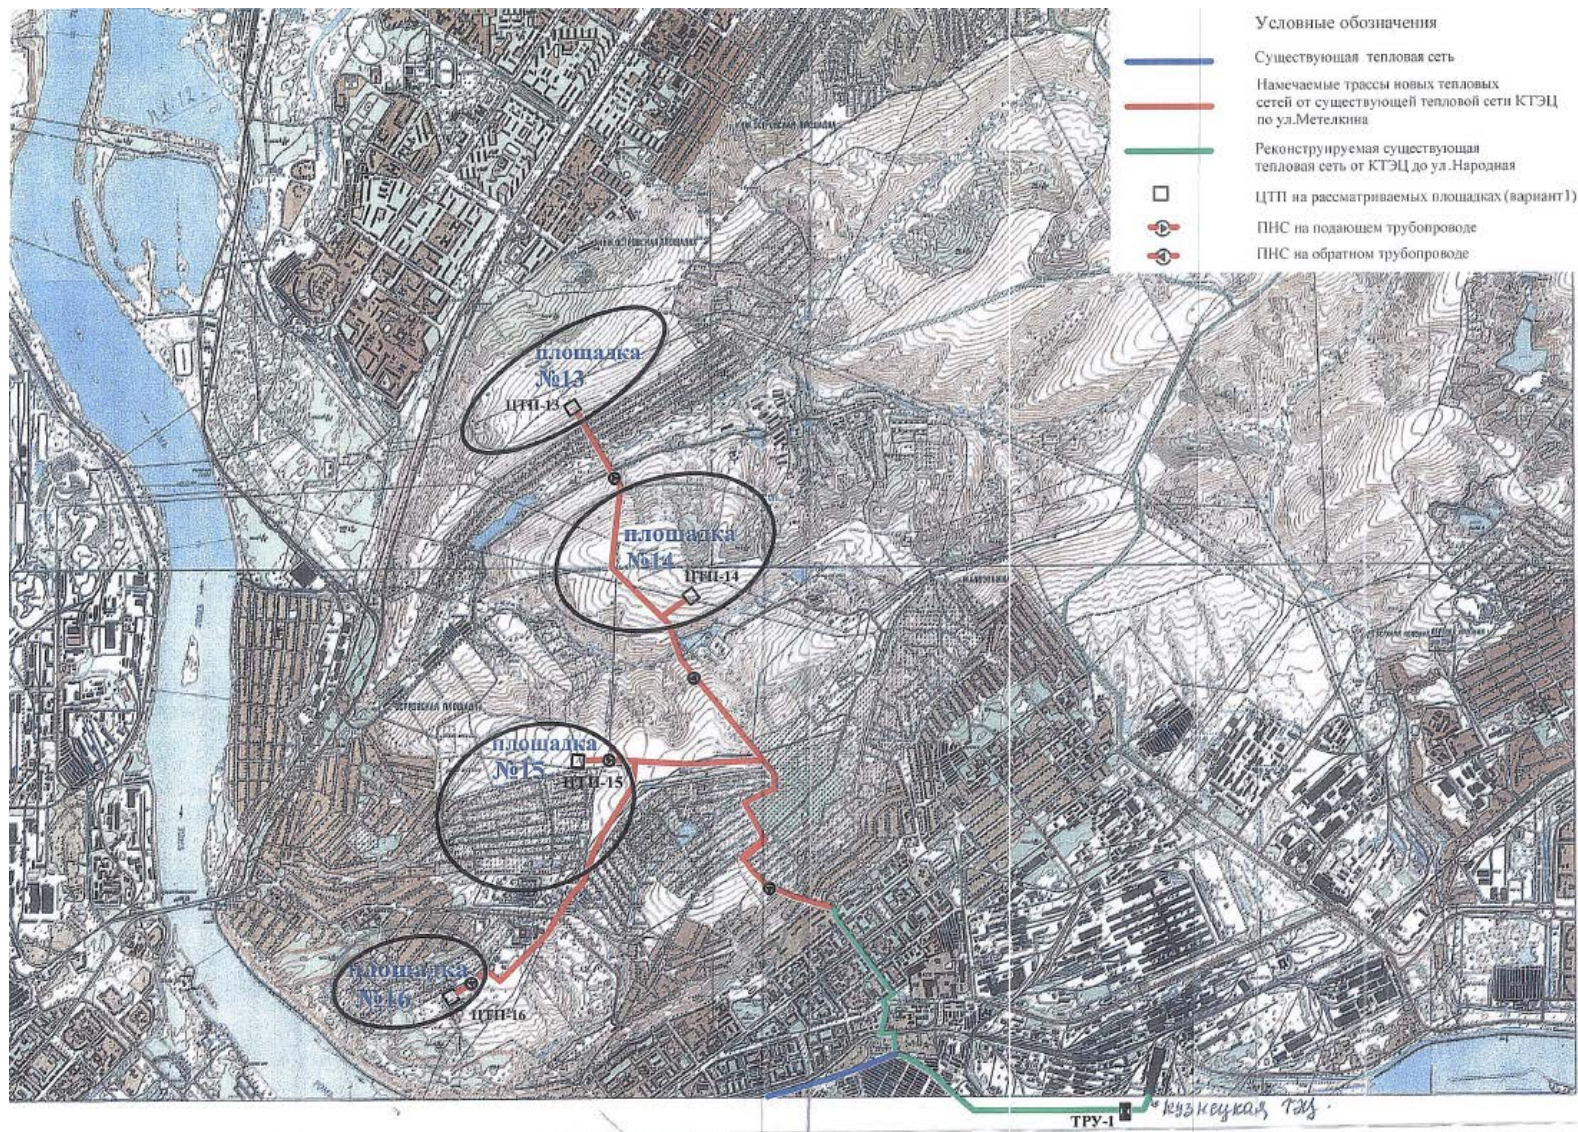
Ситуационный план размещения новой жилой застройки в Заводском районе (площадки 13, 14, 15 и 16)
